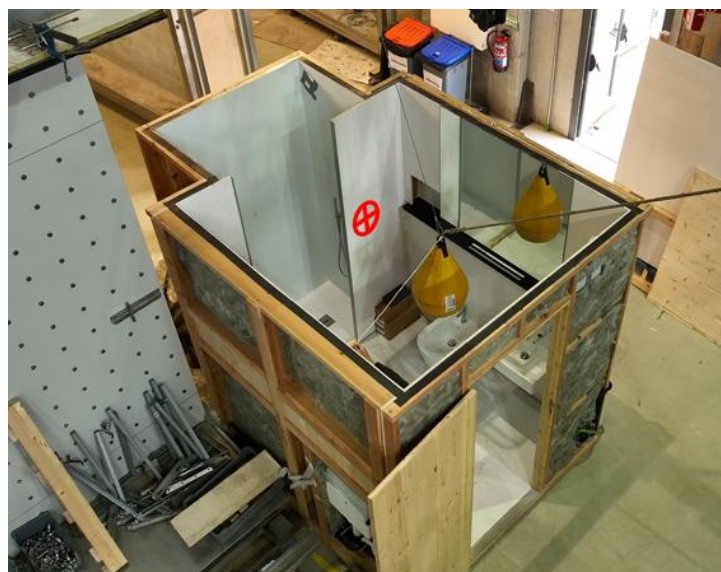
Ensaio de impacto na parede divisória da zona de duche.
